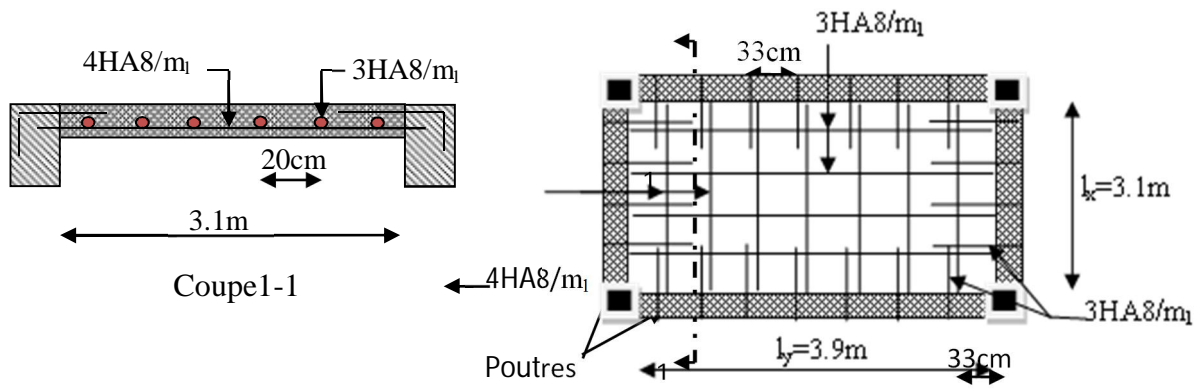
Schéma de ferrailage des dalles RDC et D₅
